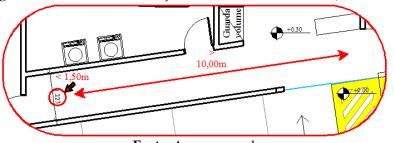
Planta Baixa - Pavimento térreo (3)
